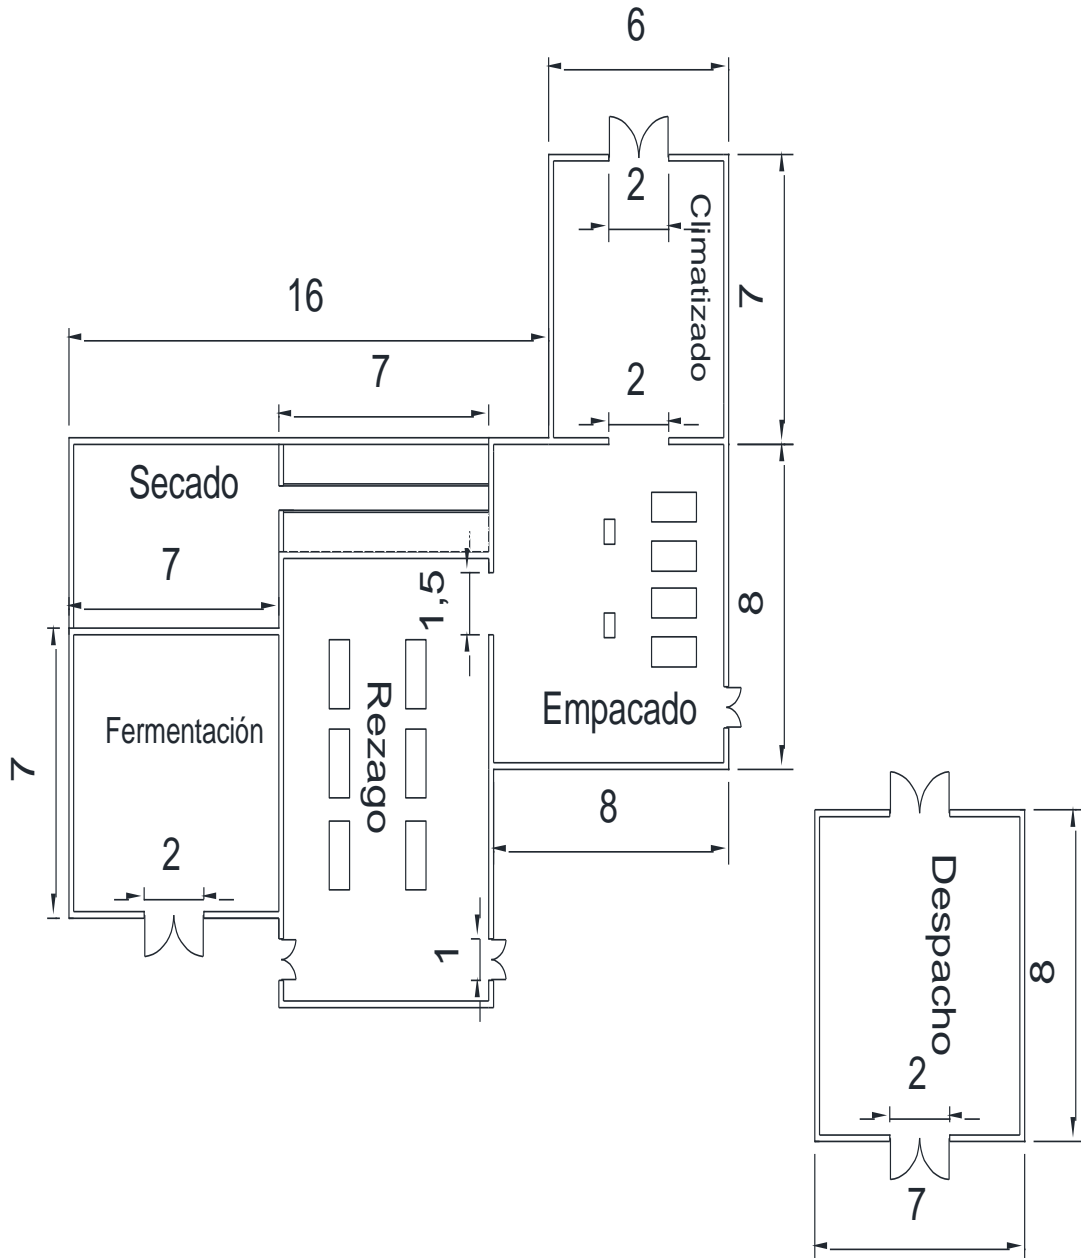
Planos de las áreas climatizado, empacado, rezago, secado y despacho
